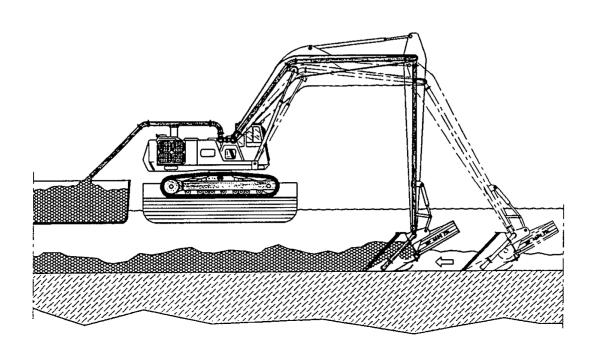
Escavatore con benna pompante su pontone galleggiante.
